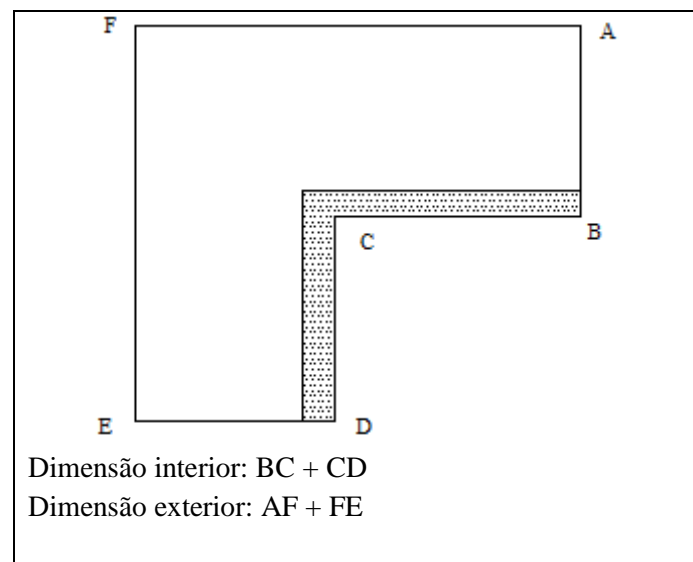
Exemplo de utilização de dimensões interiores e exteriores
